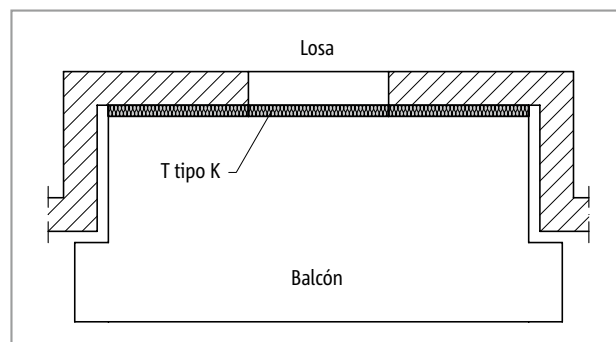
Schöck Isokorb® T tipo K: Balcón en fachada retranqueada
